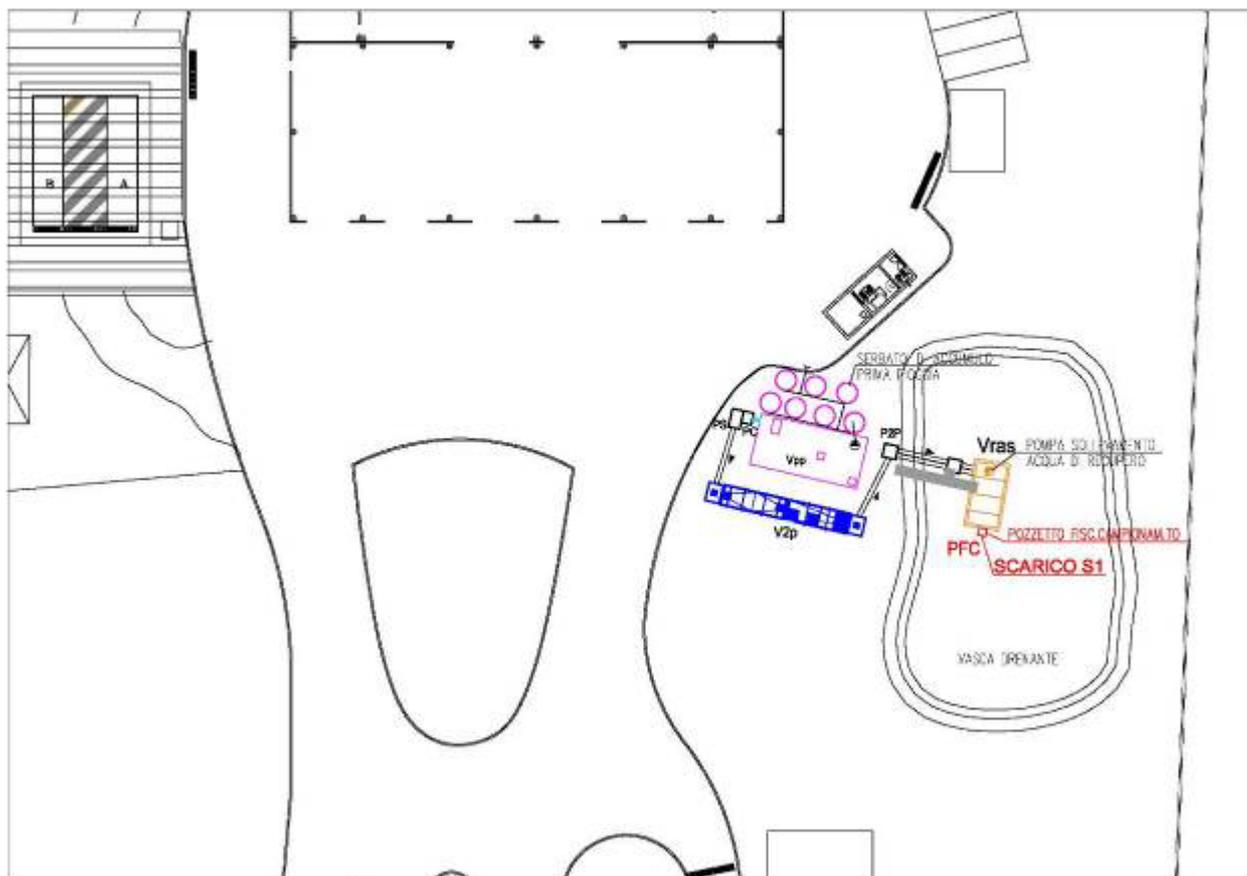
Planimetria Insedimento - ubicazione dell'area
